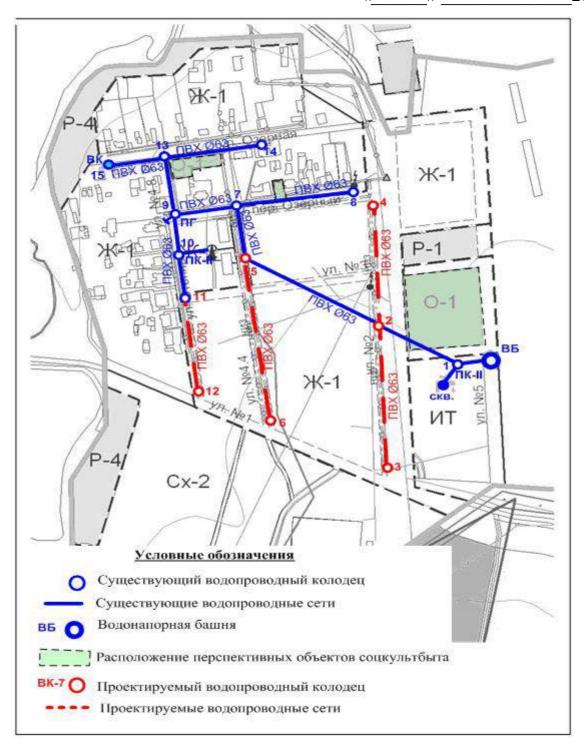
План водопроводных сетей на момент развития схемы водоснабжения п. Песчаный Дол
